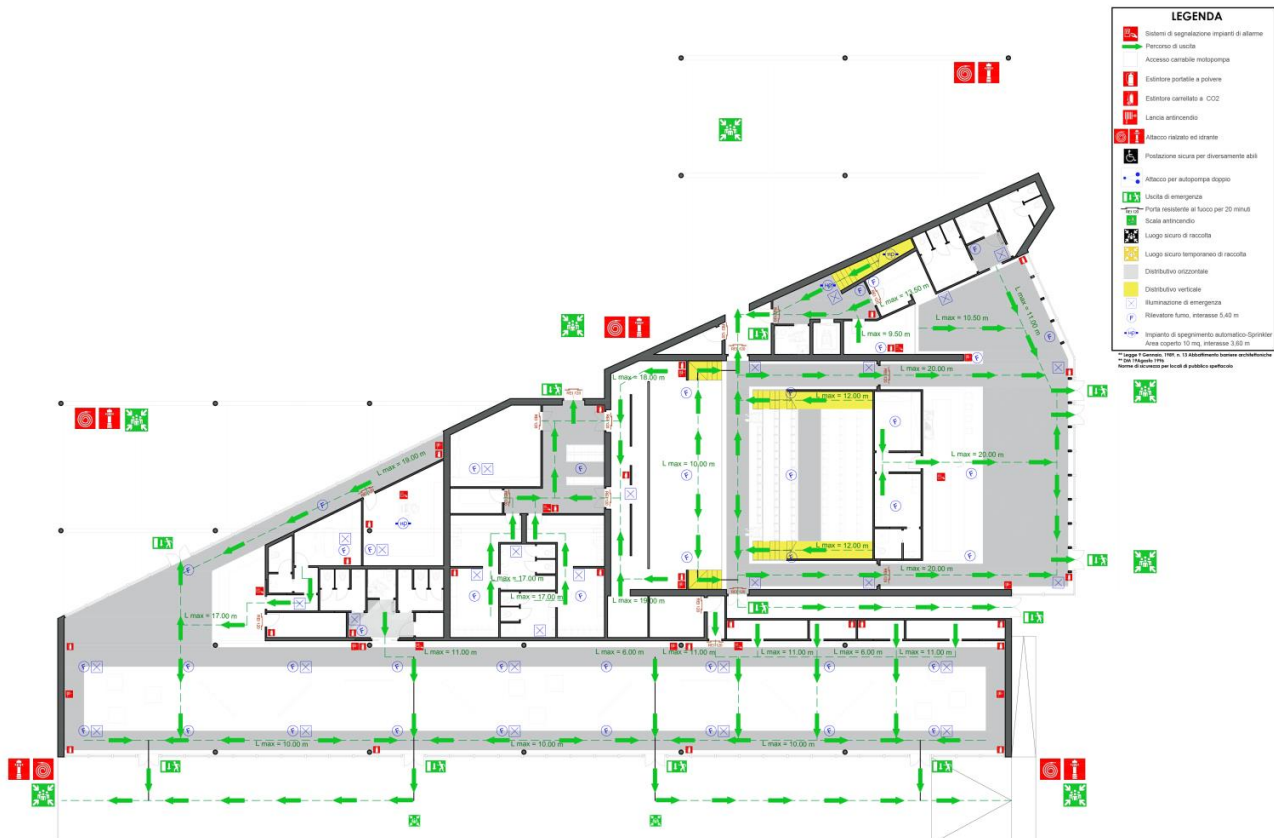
Pianta antincendio piano terra auditorium e museo
